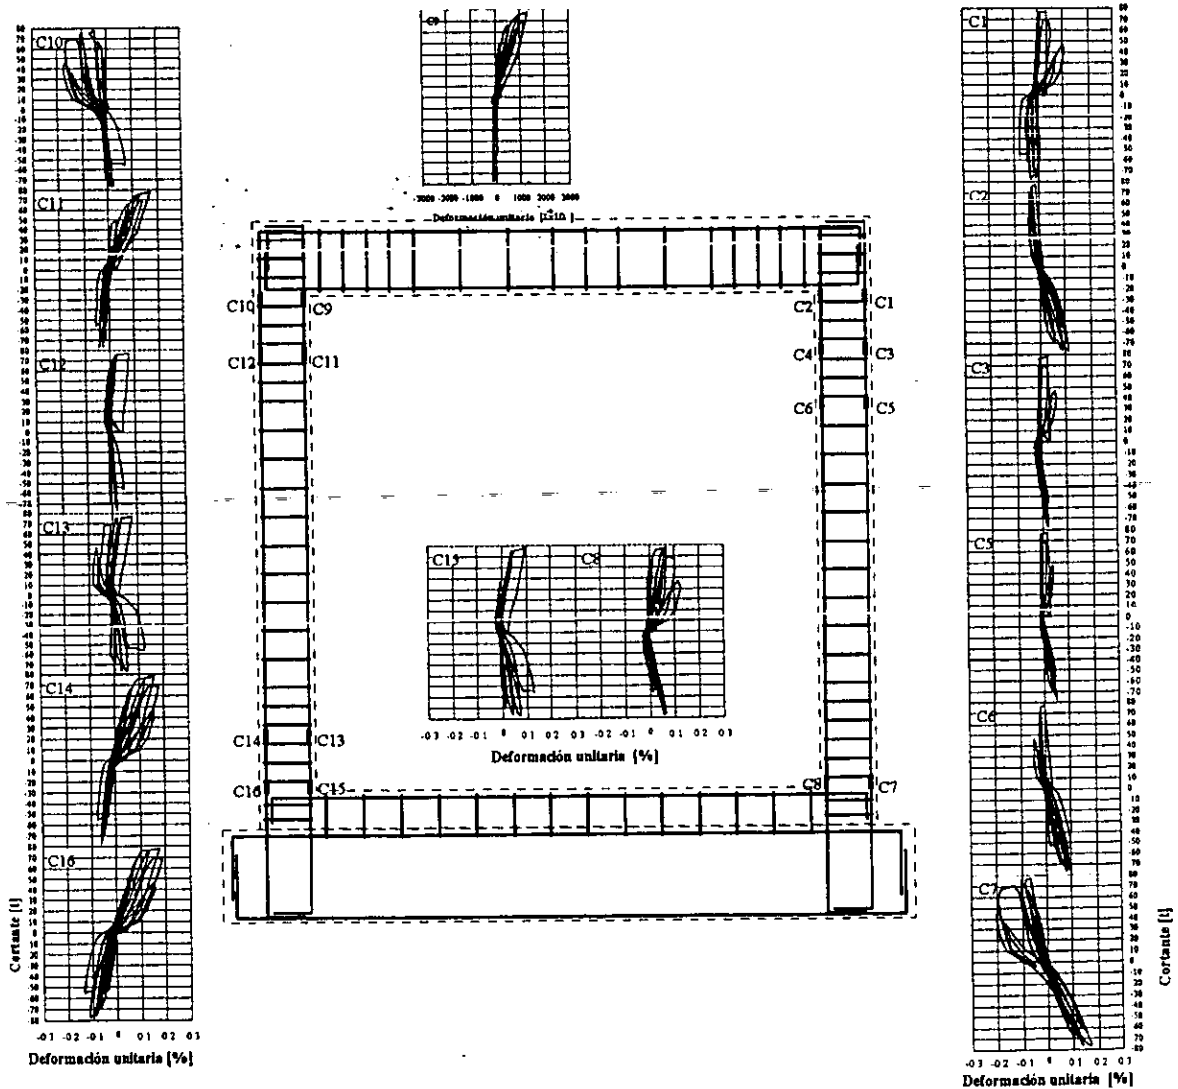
Deformímetros ubicados en el acero longitudinal de las columnas
